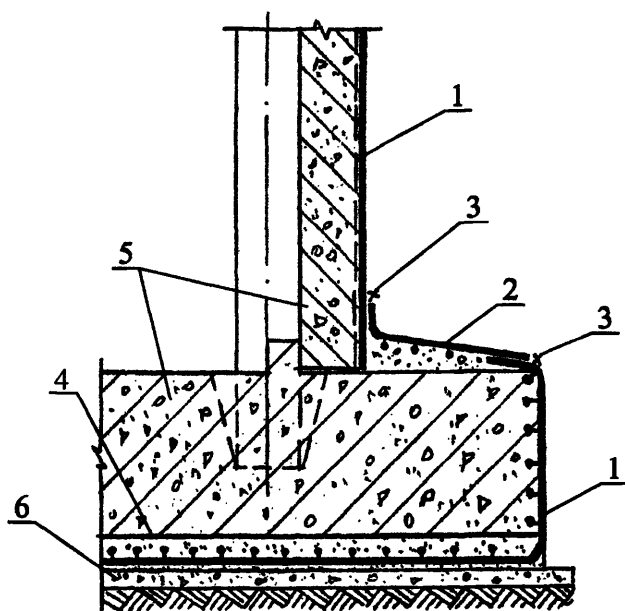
Гидроизоляция из полиэтиленовых листов для сборных конструкций стен, разрез по стене
